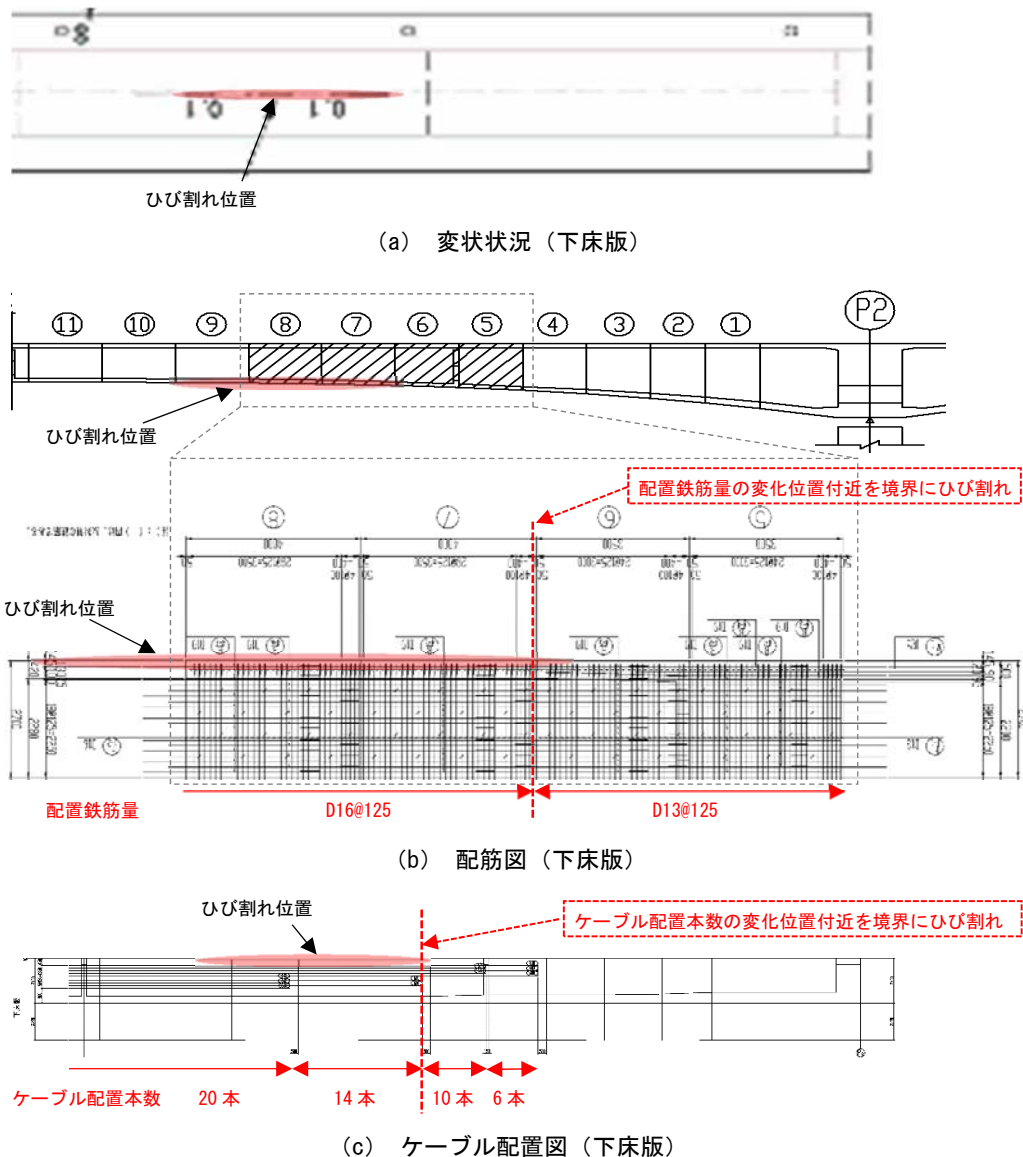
ひび割れ位置と配置ケーブル本数及び鉄筋量 (橋梁 No.9)
